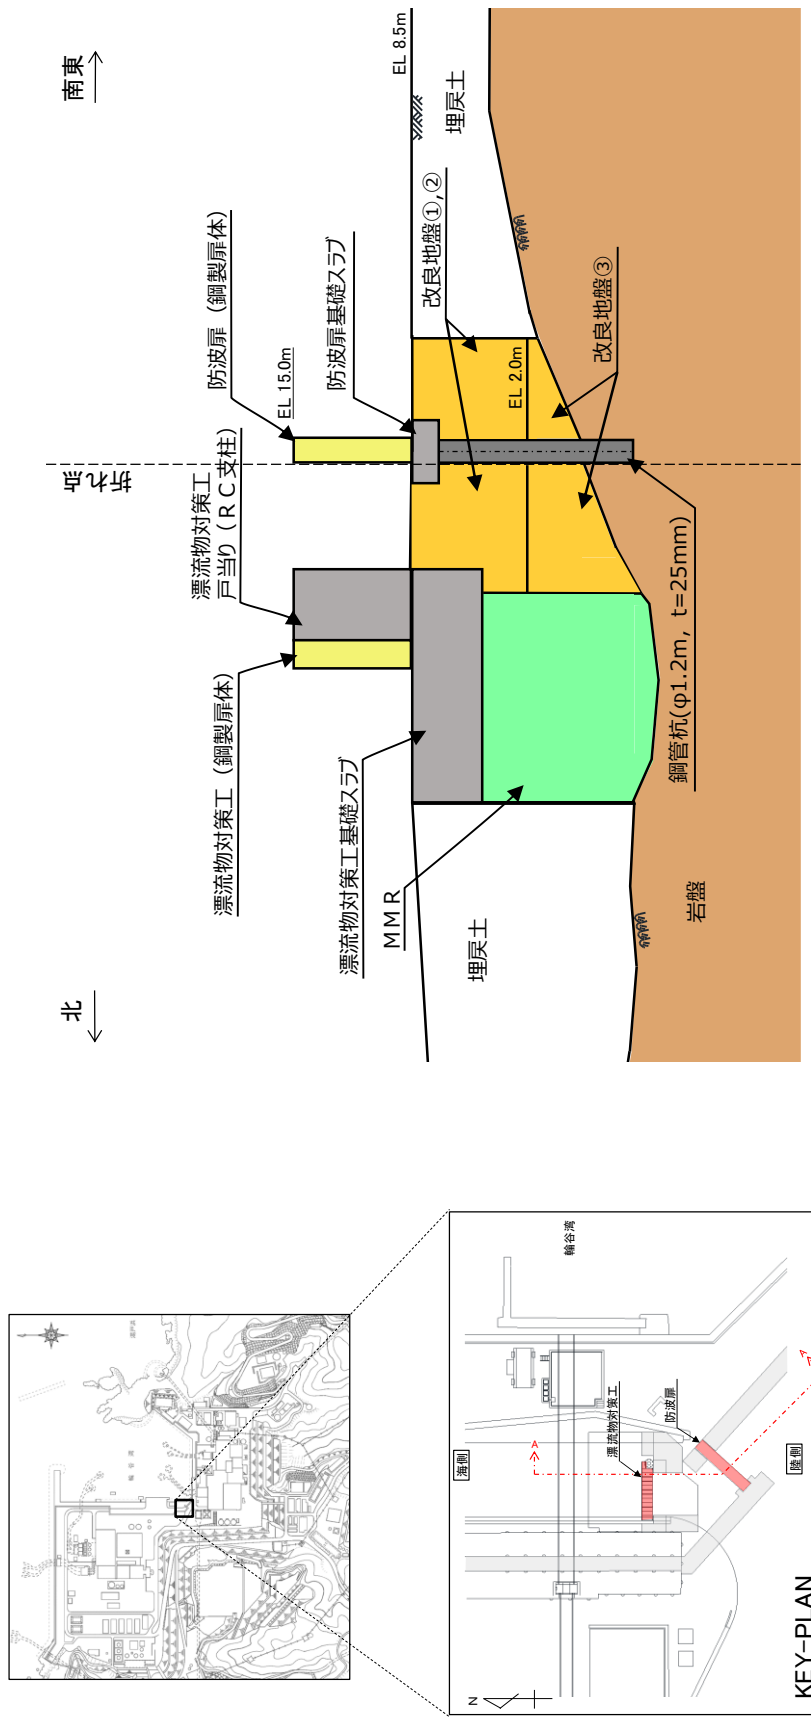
防波扉 (荷揚場南) の構造概要図 (断面図)
